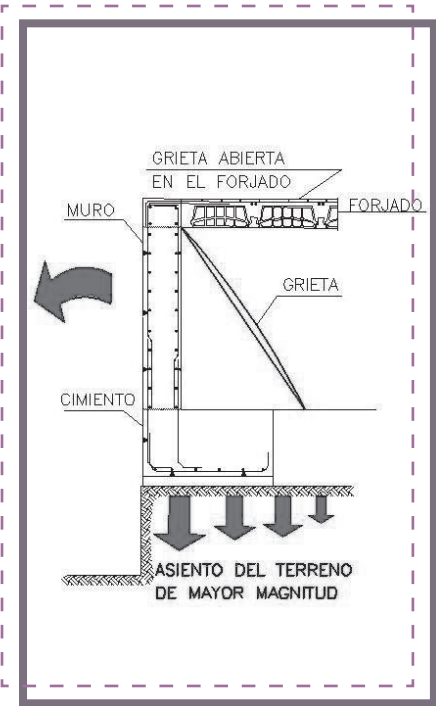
Esquema de las fisuras por asiento de una cimentación corrida de hormigón armado.
